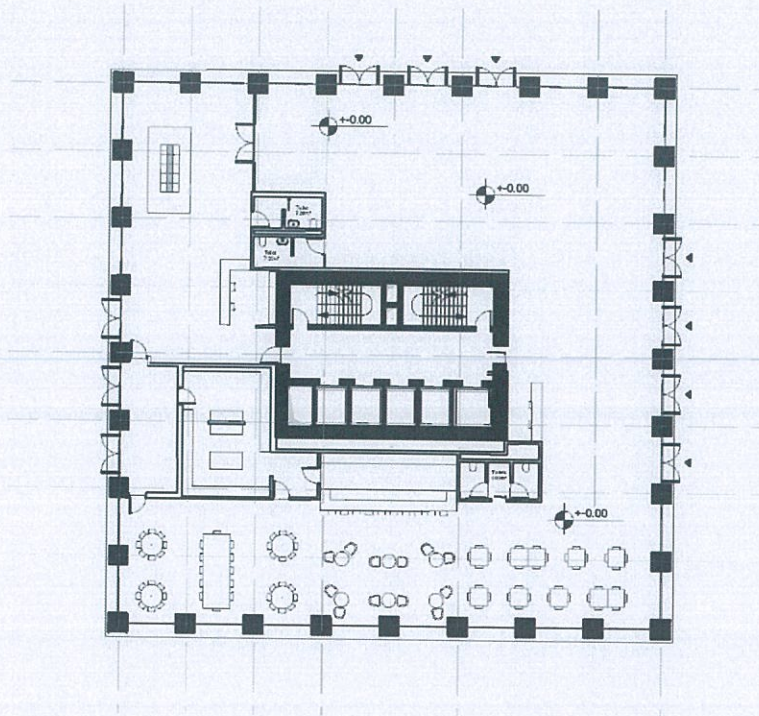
Planimetria e katit përdhe, në kuotën +0.00
